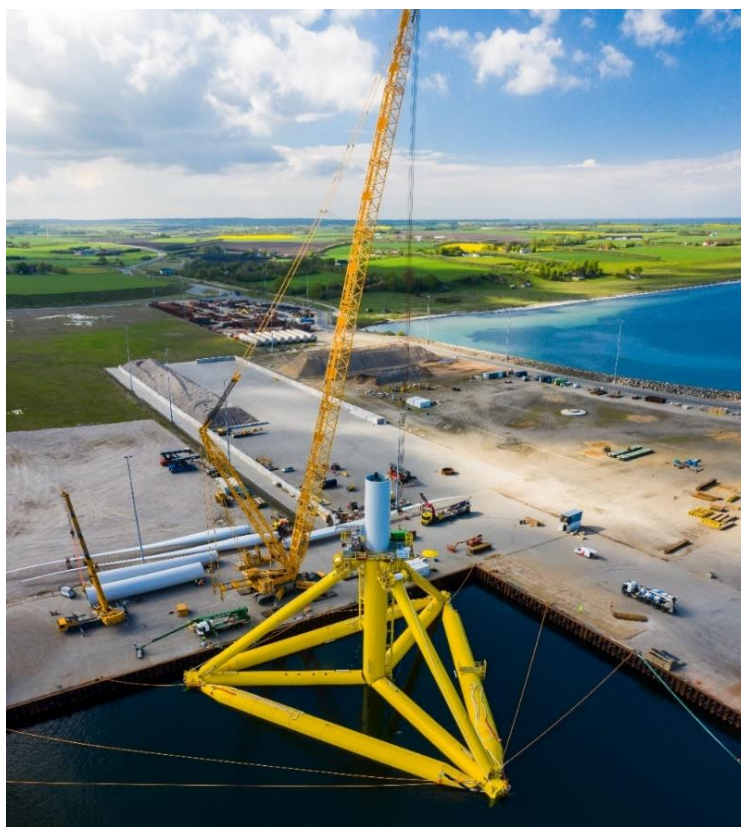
Assemblaggio della turbina Siemens Gamesa da 3.6 MW sulla fondazione galleggiante *TetraSpar
